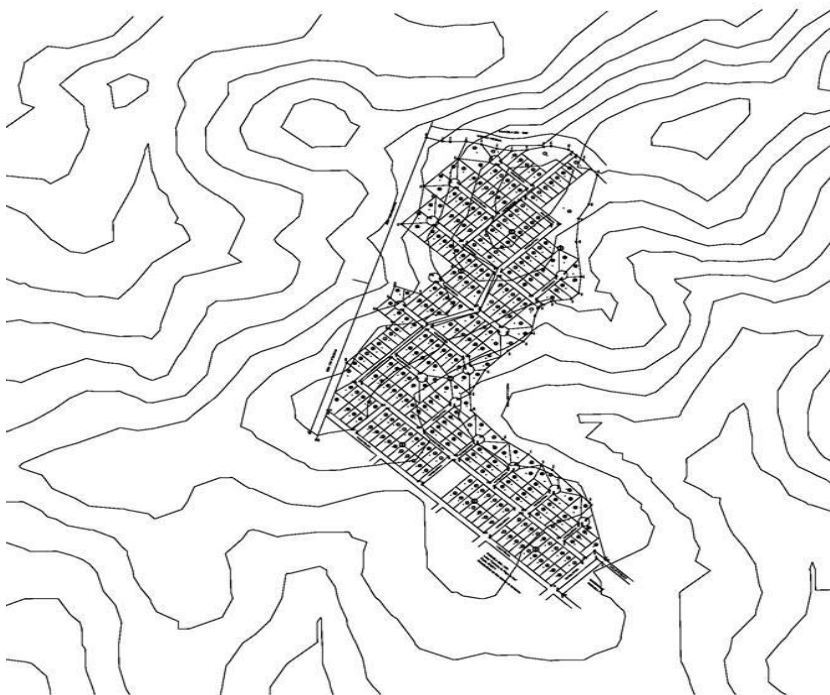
Plano adjunto Planialtimetría-Proyecto definitivo
